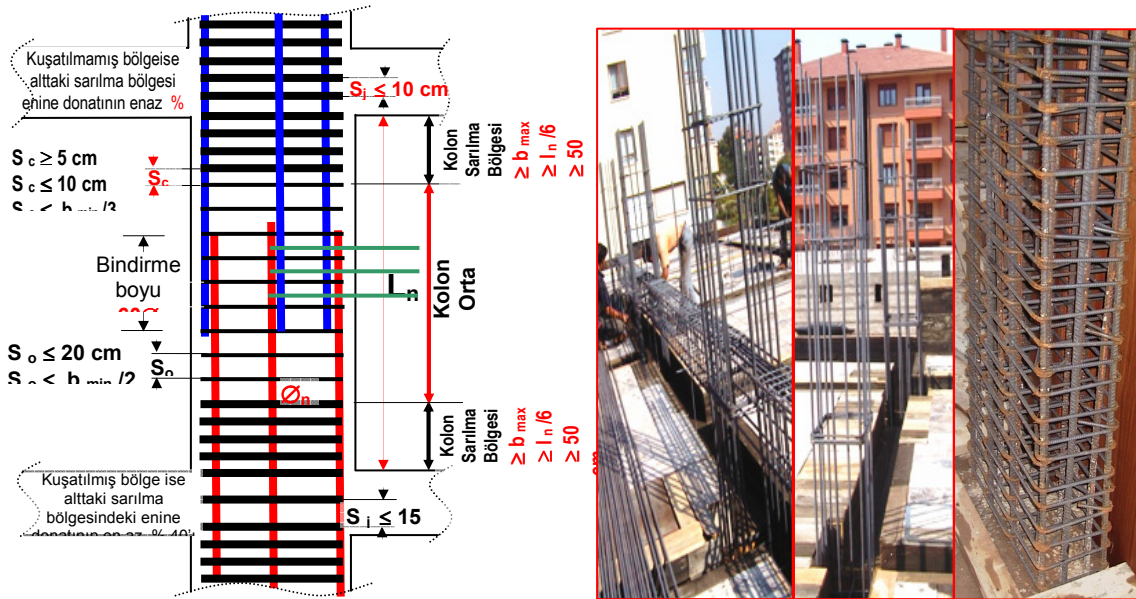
Kolon kiriş birleşim uygulamaları
